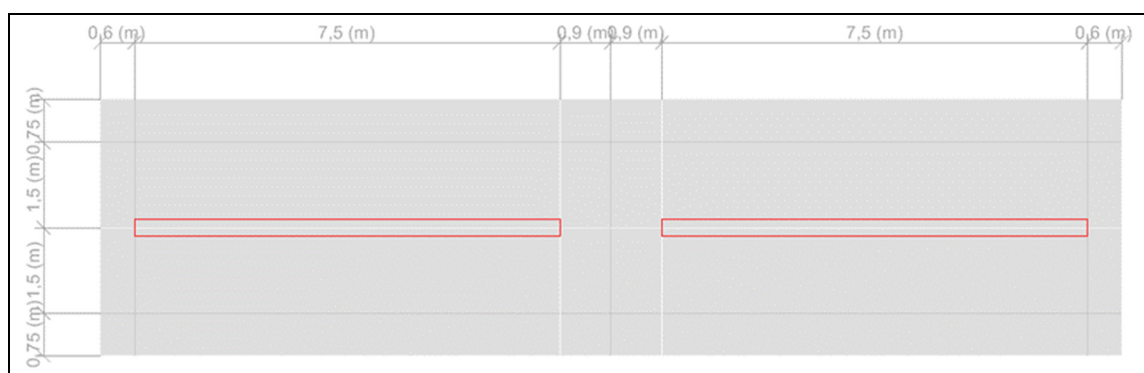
Zoom planta del edificio de estudio con muros rectangulares.
